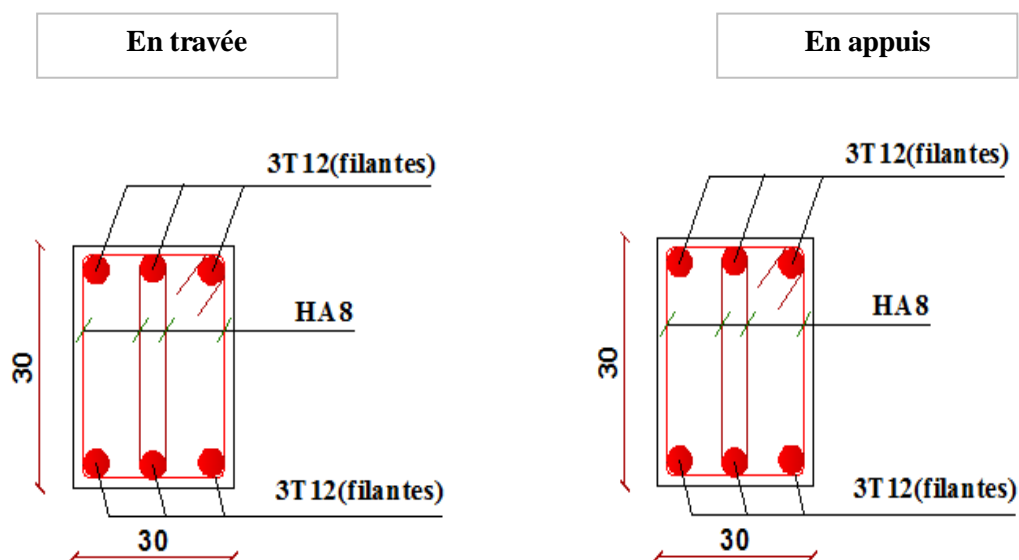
Ferrailage des poutres principales de 3<sup>ème</sup> système
